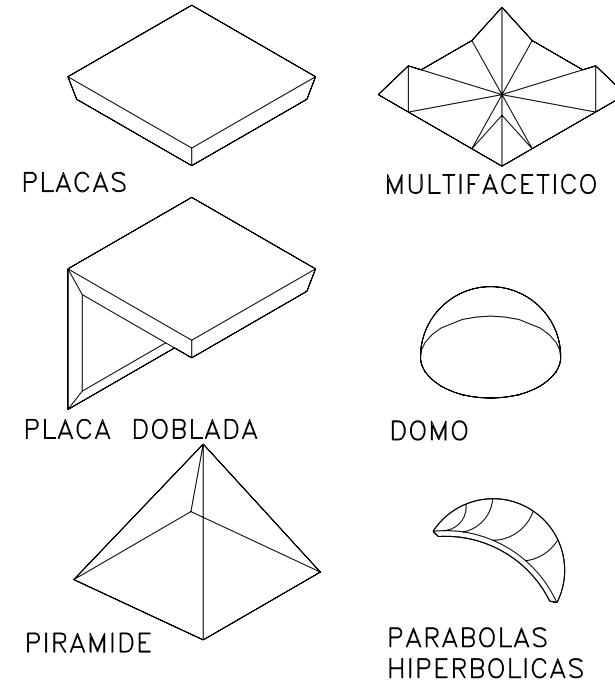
Por su configuración en el conjunto los sistemas de reticulado pueden tener estas formas.
